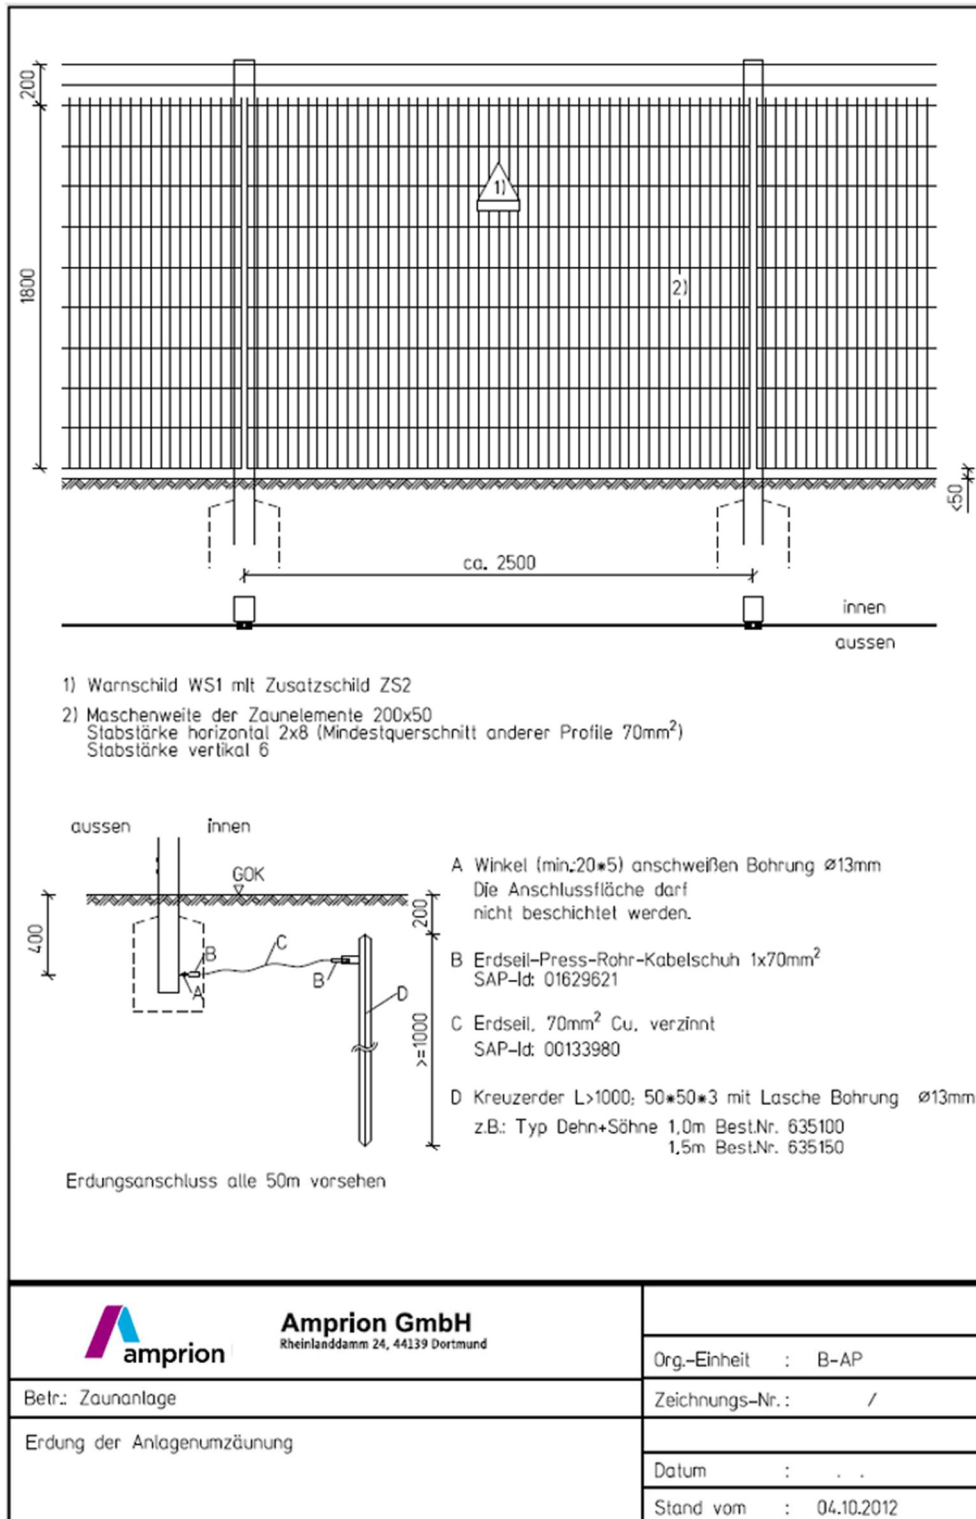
Bauplan zur Erdung der Anlagenumzäunung
